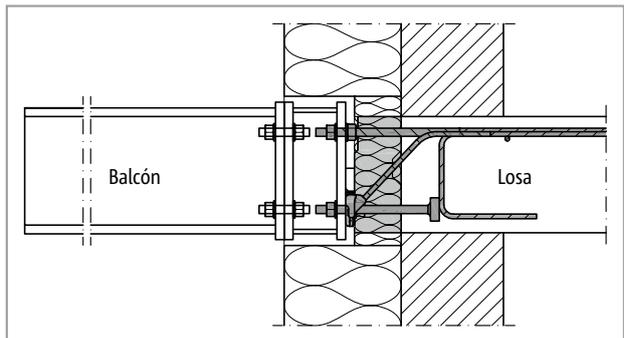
Schöck Isokorb® T tipo SK: Conexión del soporte de acero a un adaptador que compensa el espesor del aislamiento exterior
